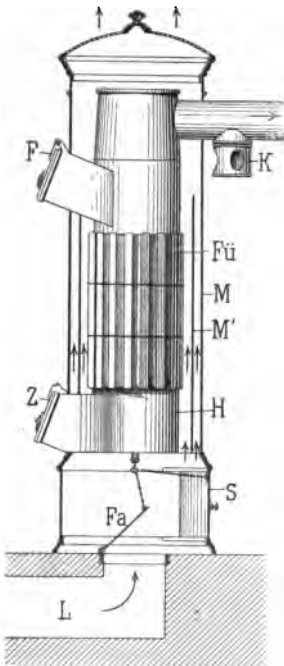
Weibingerofen, innerer Bau; Einrichtung für die Luftzufuhr ins Zimmer.
